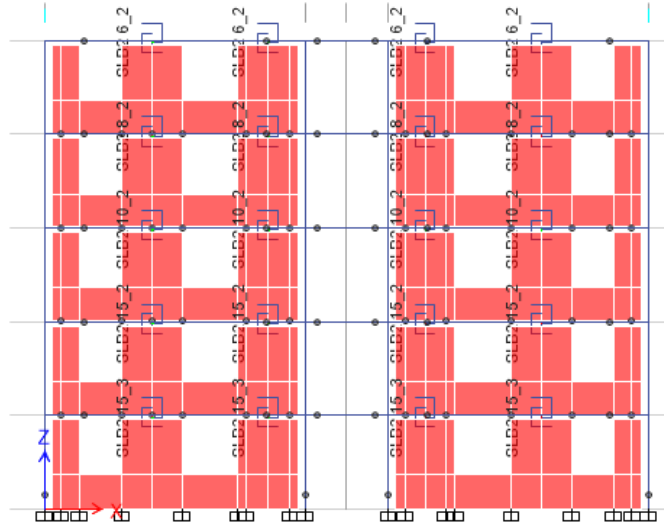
17. Edificio prefabricado SLB, bases articuladas de sus columnas
